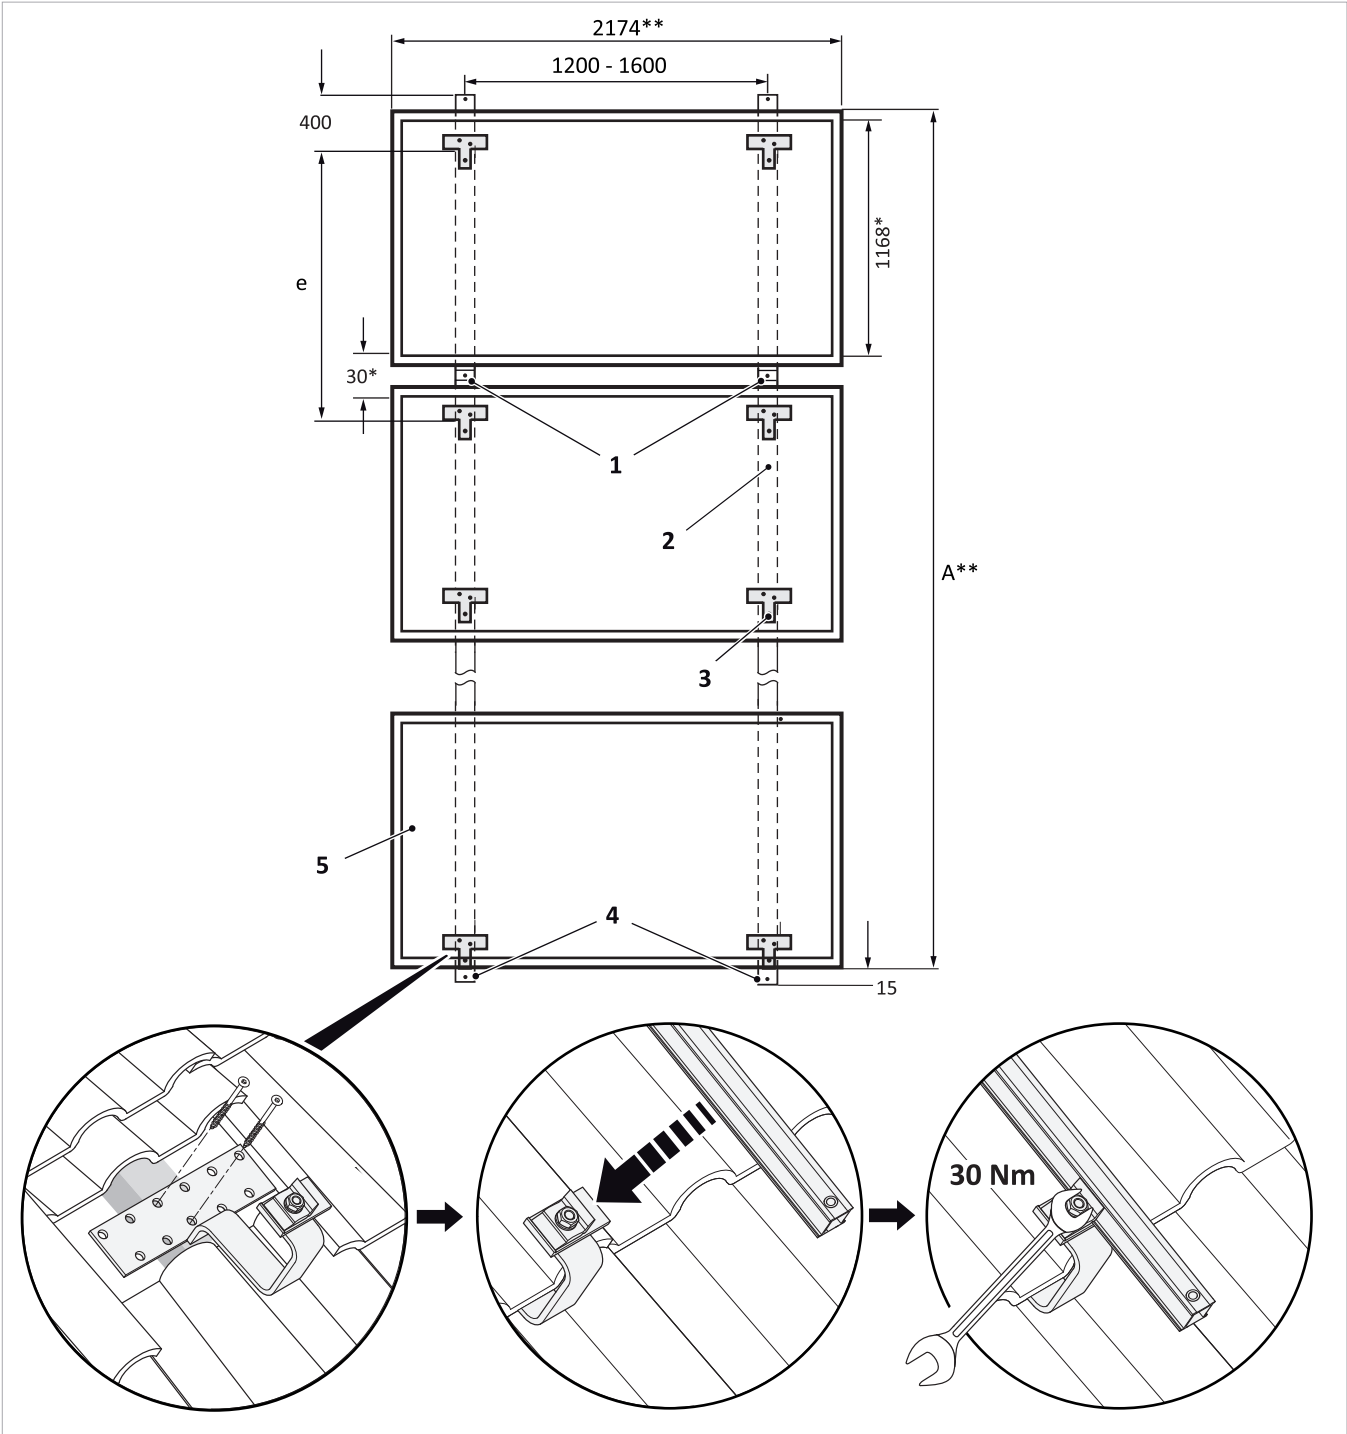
montage superposé des fixations sur toiture et des rails de montage.
